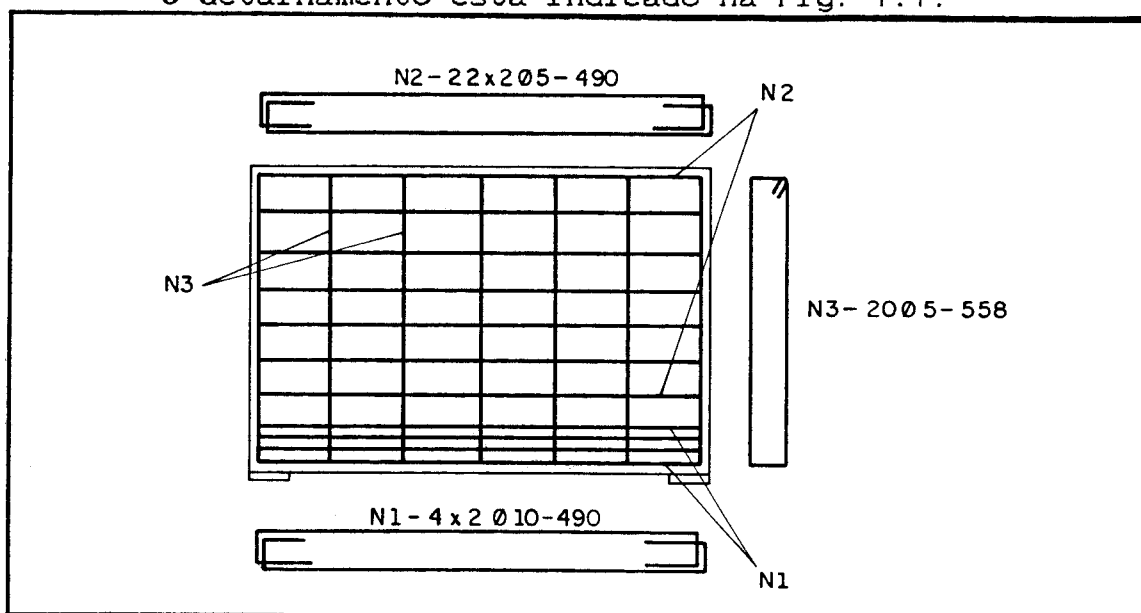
Detalhamento da viga-parede do exemplo 4.
